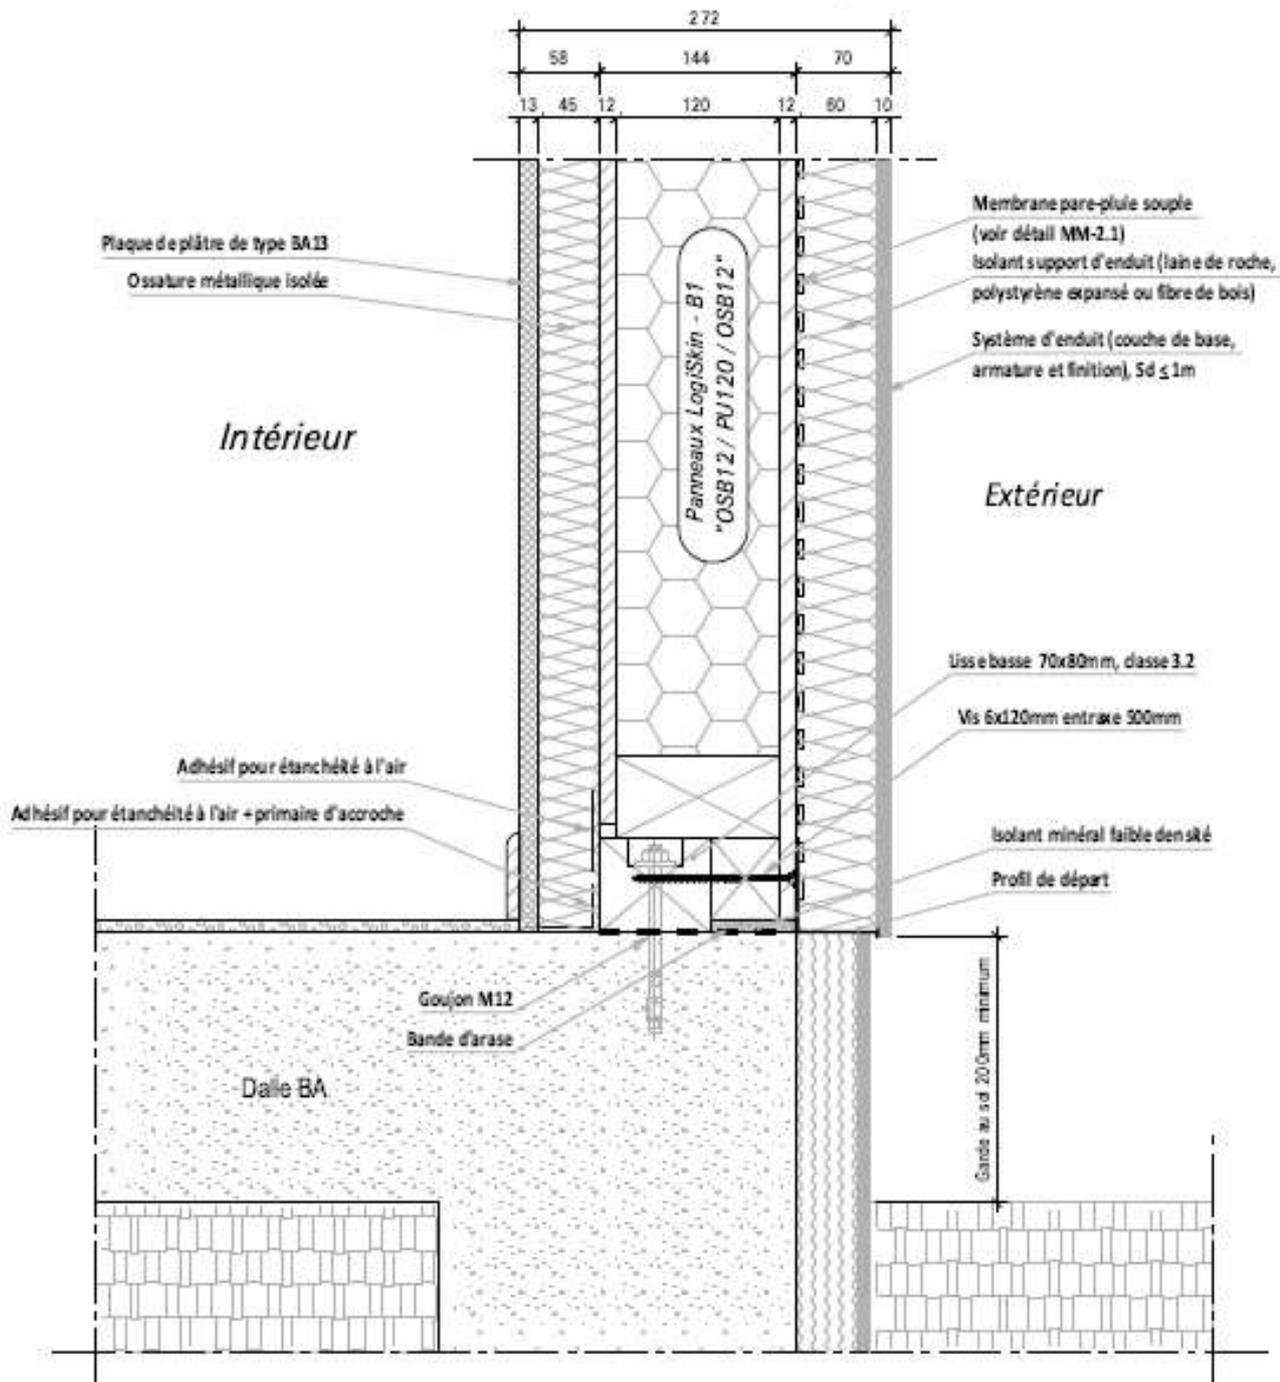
Détail CV-1.1 – pied de façade – Mode de pose 1 et 2-1
